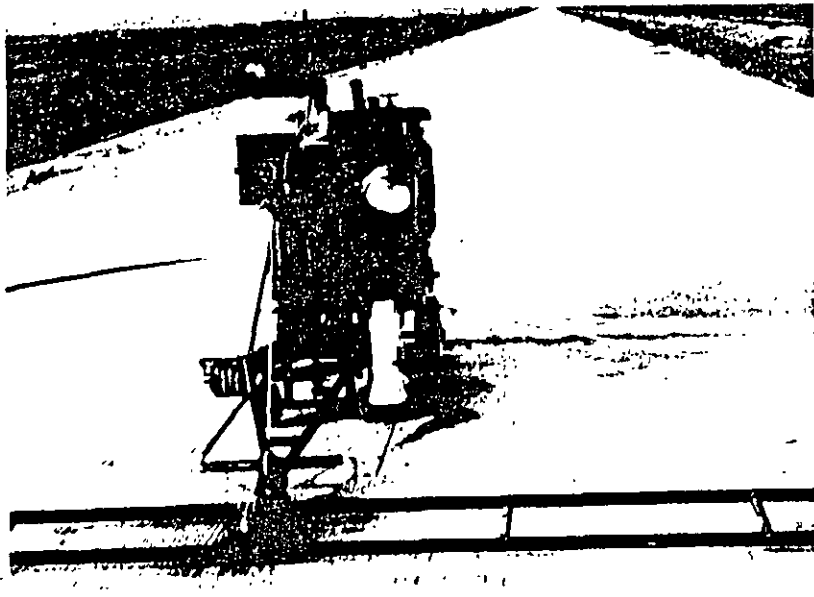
Aserradura de una junta longitudinal de contracción.
